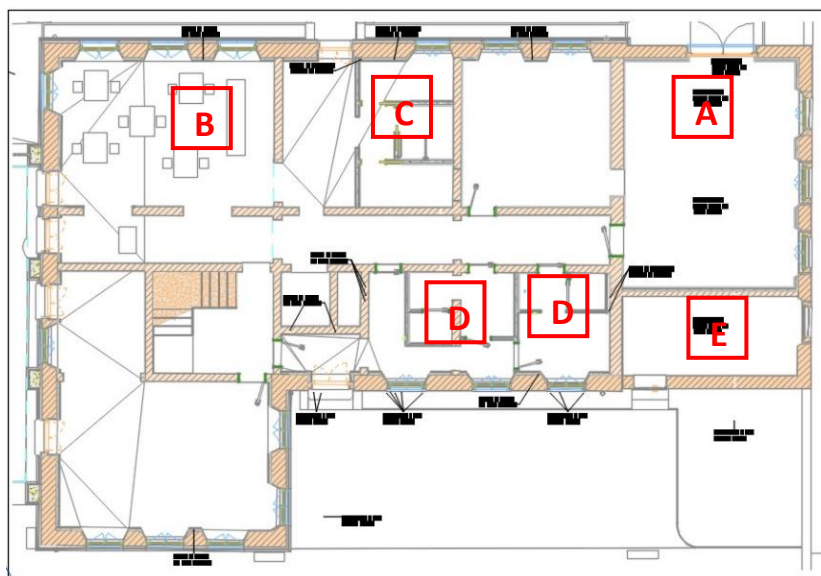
Immagine della planimetria del piano terra del fabbricato oggetto di adeguamento.
